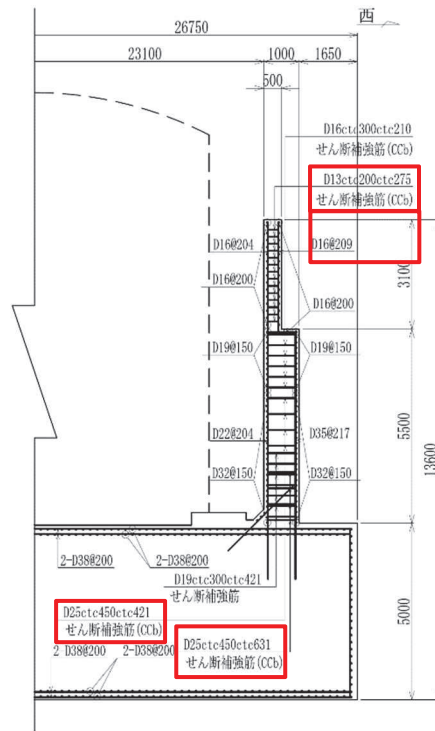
復水貯蔵タンク基礎 概略配筋図 (平面図)
